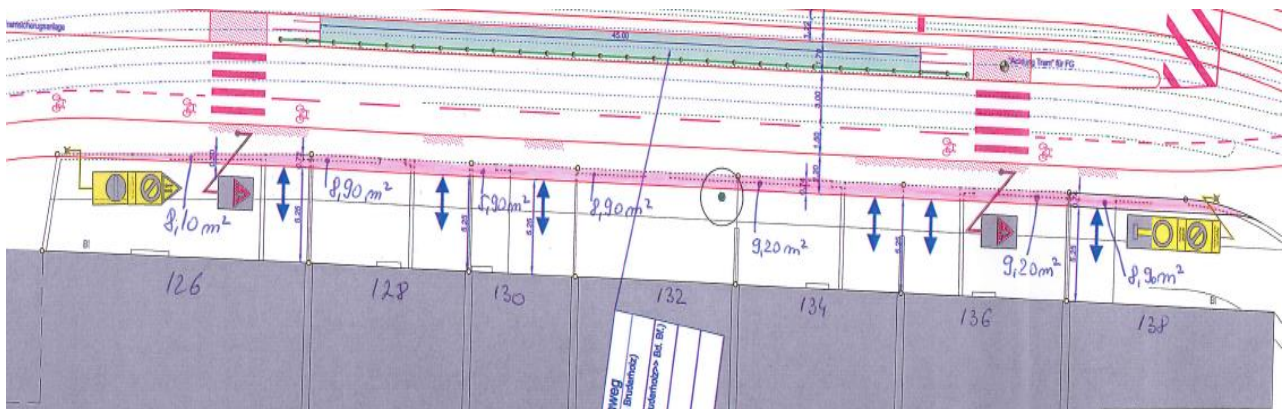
; Projekt – Planausschnitt, Reinacherstrasse Haus-Nr. 126 bis 138, Landerwerb
